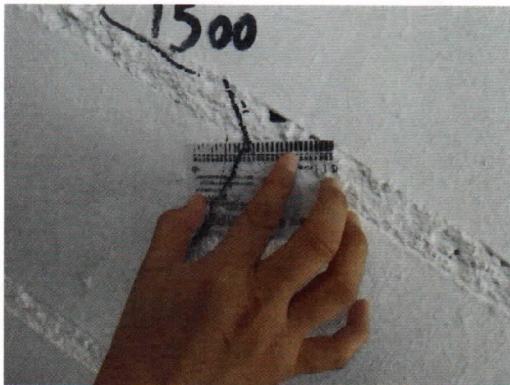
Espesor de grieta de 0.4mm en ladrillo de la cara Sur para una distorsión de 1/1100.
